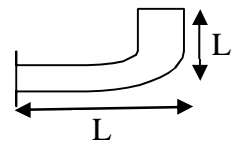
Disposition du ferrailage de la poutre de palière.
